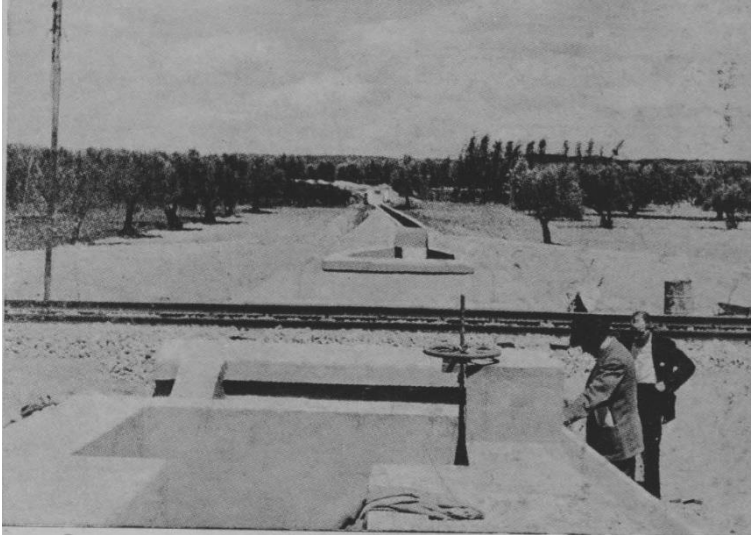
Sifón en las cercanías de Calera y Chozas construido para poder sortear la vía férrea.
